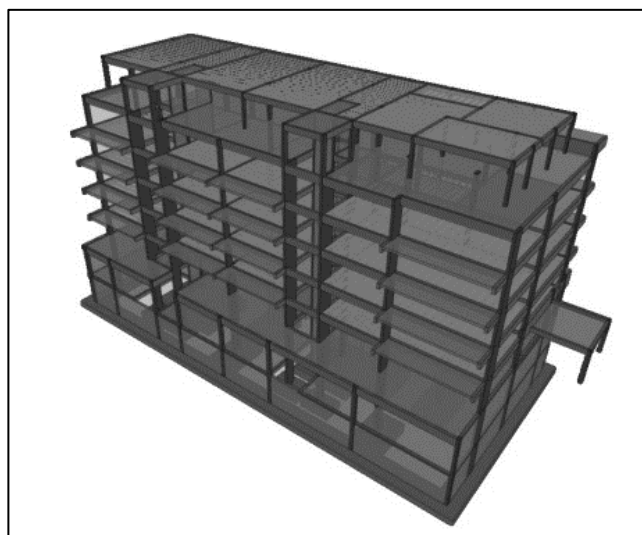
Esquema tridimensional da estrutura do edifício Altavista 16 (1).
